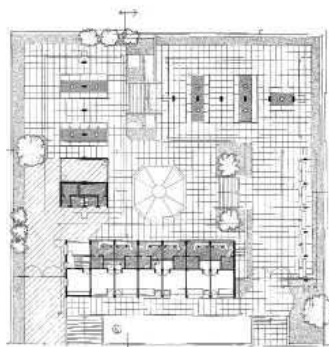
Planta Mercado Vila da Feira, Fernando Távora
